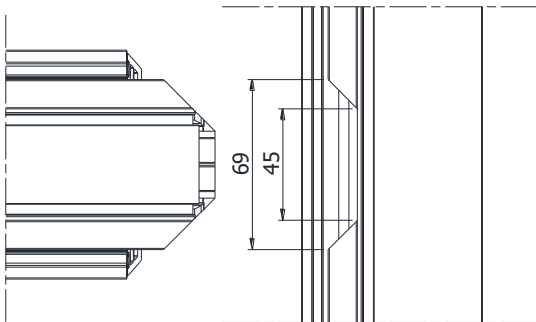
DETAIL ASSEMBLAGE BATTEMENT CENTRAL
